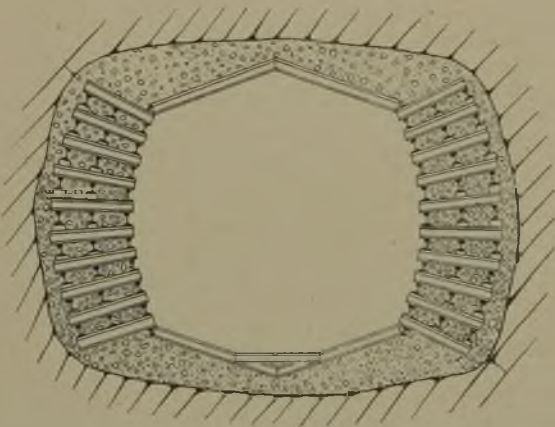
Betonausbau mit eingelegten Eisenbahnschienen.
